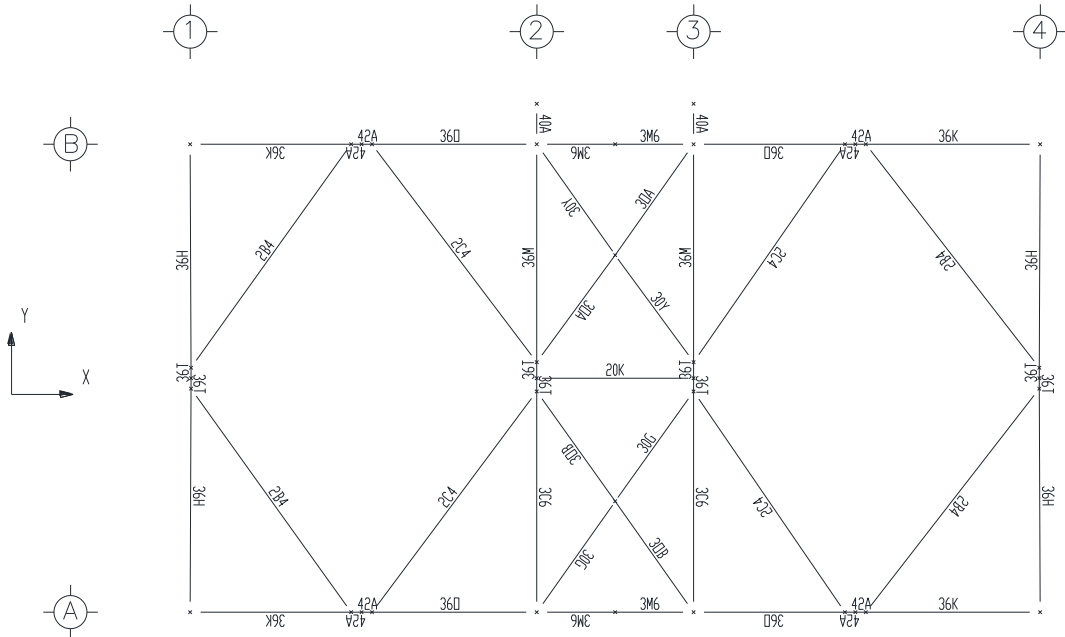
Grupos en Elev. (-) 102.234 m, subestructura
